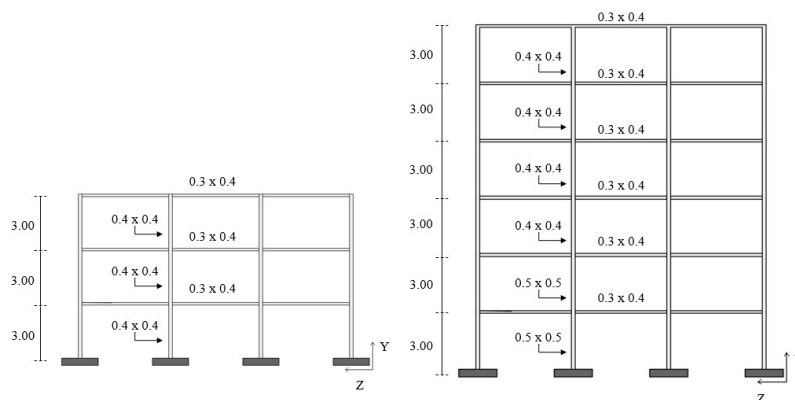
Sezione verticale degli edifici caso studio (unità di misura: metri)
